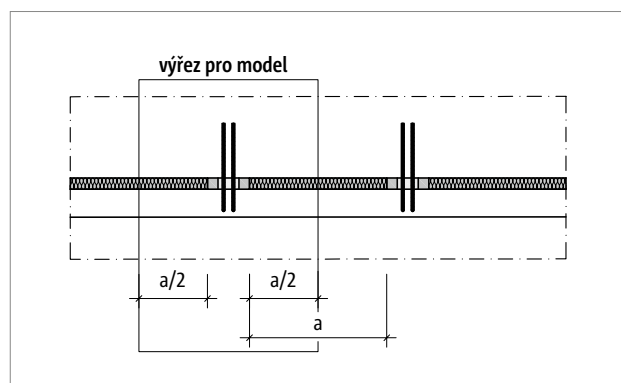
Řez zobrazující detailní model prvku Schöck Sconnex®
